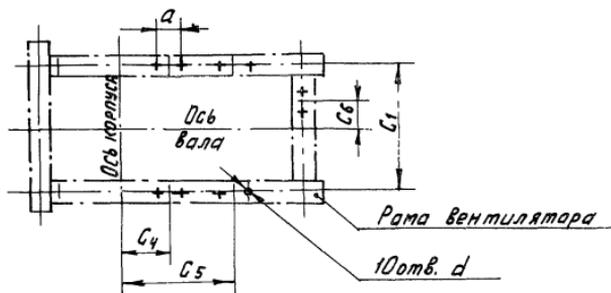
ВЕНТИЛЯТОРЫ В-Ц14-46-5 ÷ В-Ц14-46-8
